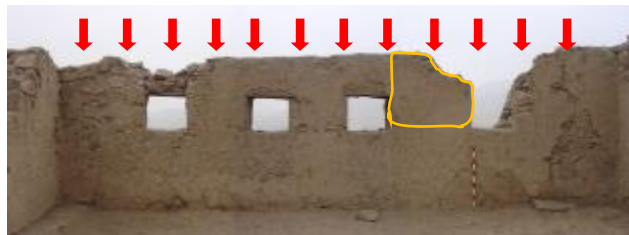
La sobrecarga en el muro ha lesionado una sección del muro
